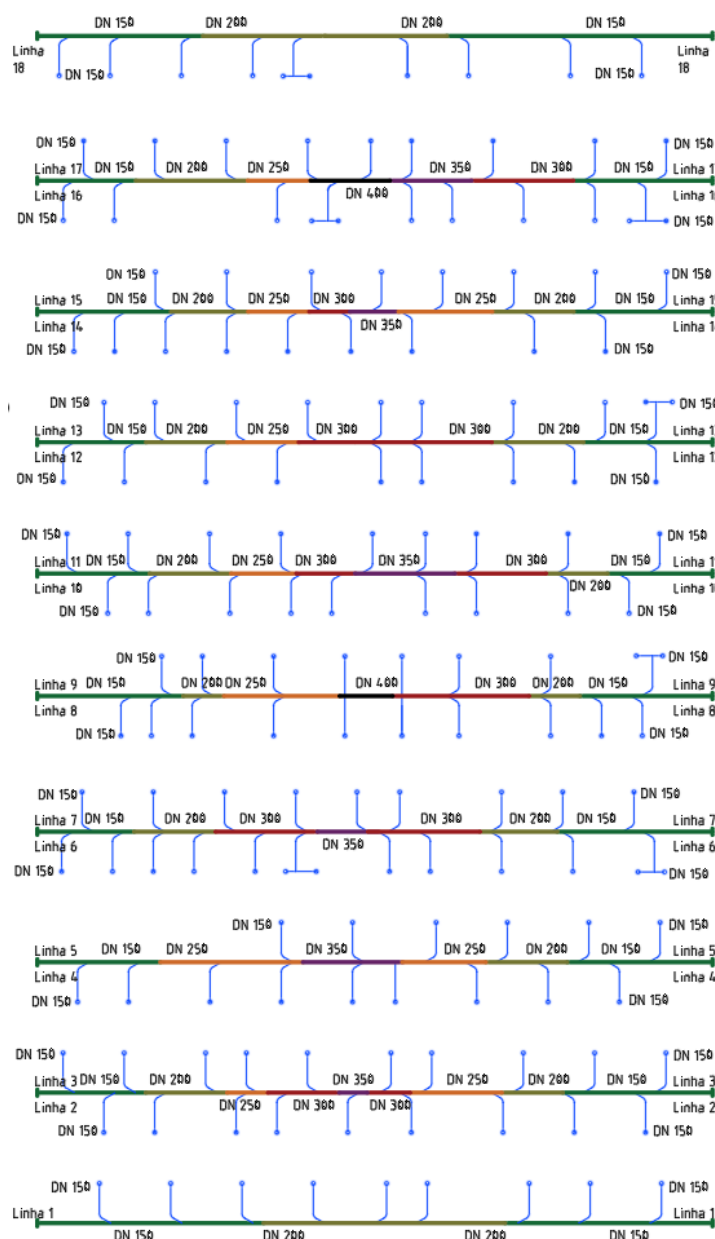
Planta das novas tubagens das condutas circulares da zona central
